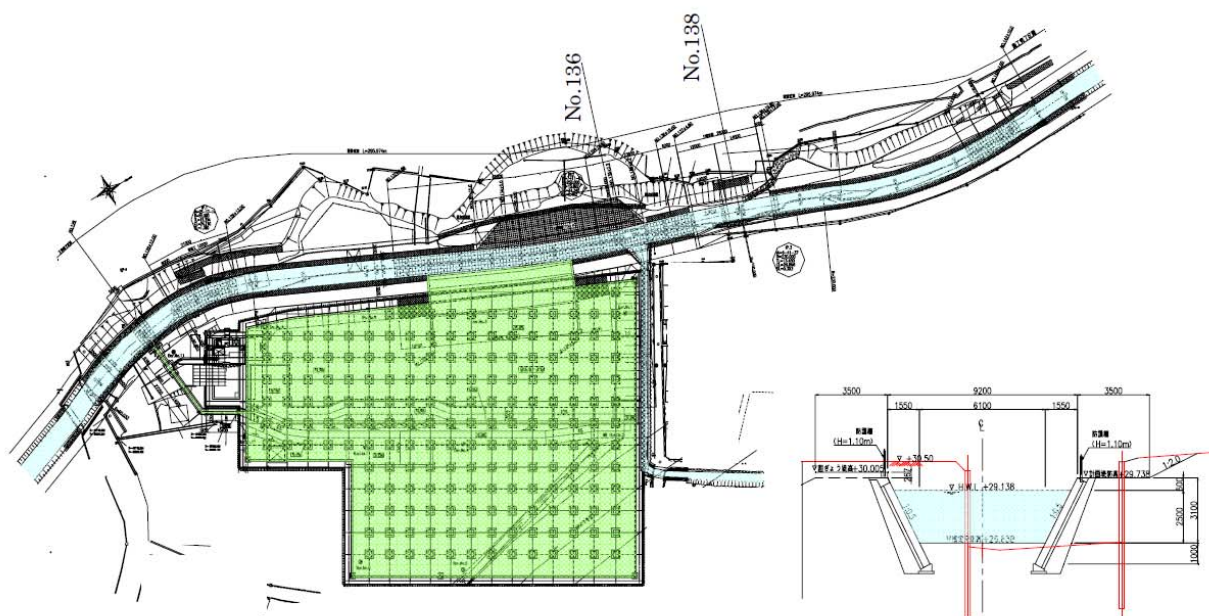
計画平面図 (青色：河川、緑色：地下遊水地)
